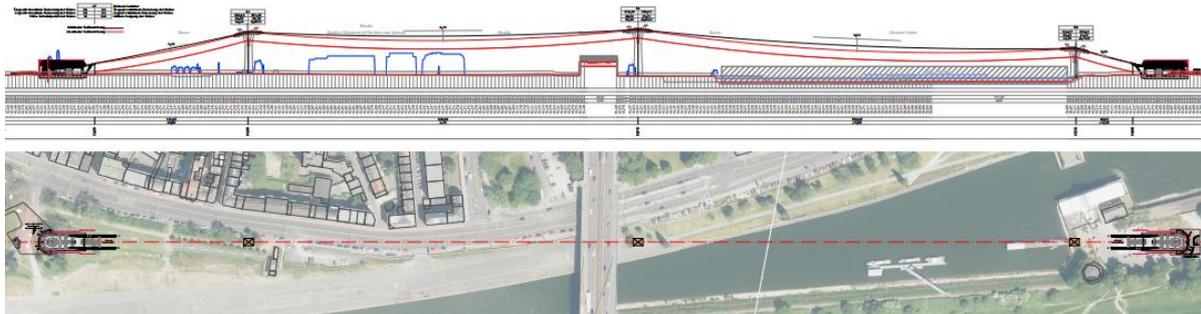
Längenschnitt, Lageplan Variante V1.6
